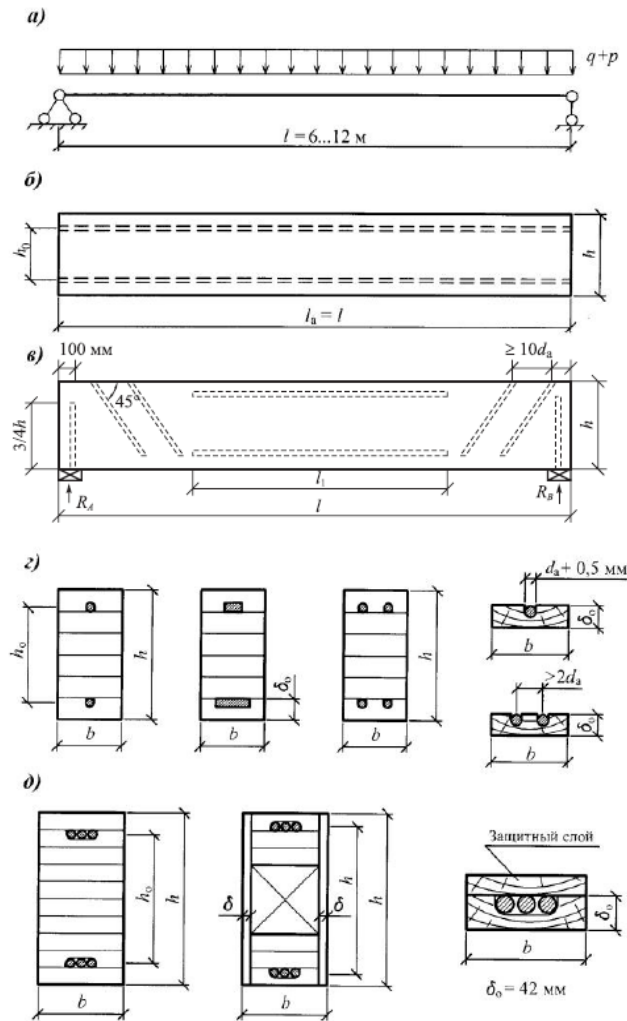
Армування клеєної дерев'яної балки: *a* – схема прикладання навантажень; *б* – схема армування балки одиночними стрижнями; *в* – схема армування балки; *г* – типи поперечних перерізів з одиночним армуванням; *д* – типи поперечних перерізів з груповим армуванням. [4].
